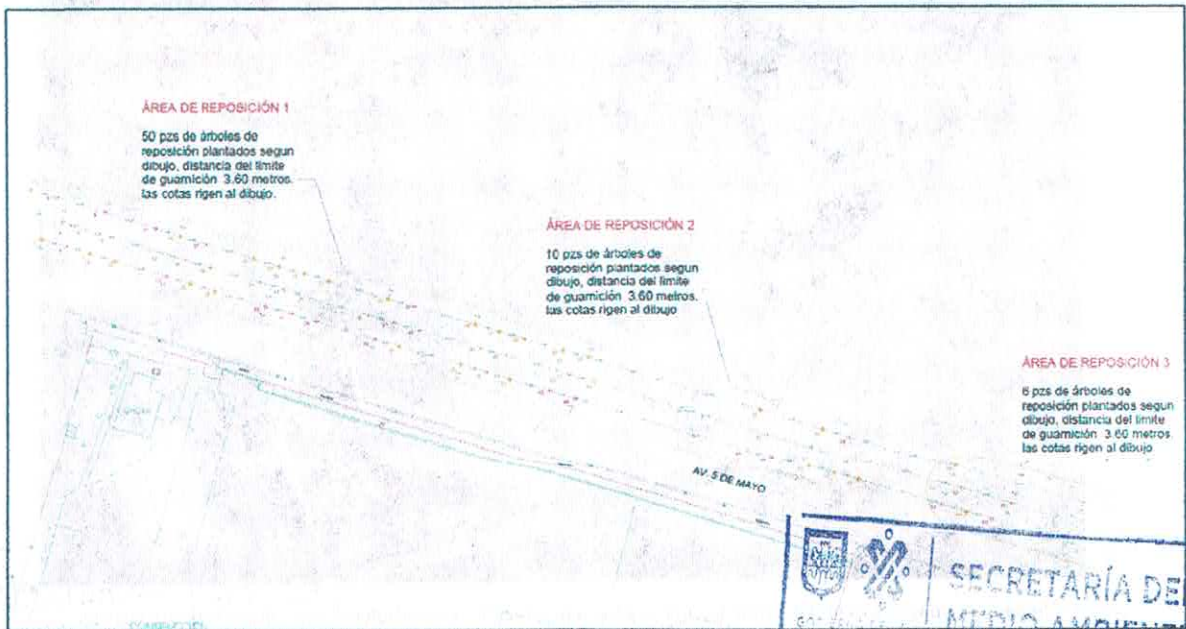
Plano del sitio destinado para la plantación de 66 árboles y rehabilitación de área verde.
